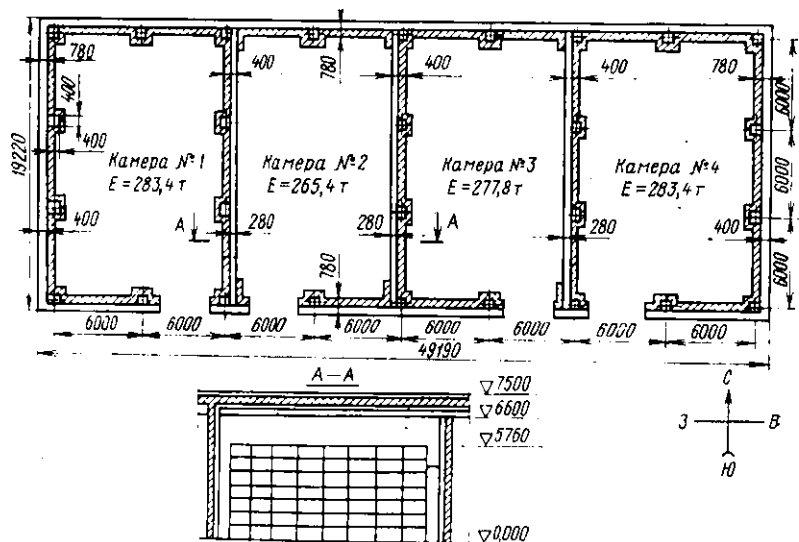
Схема холодильника к расчету теплопритоков Q_1 через стены, перегородки и покрытия
